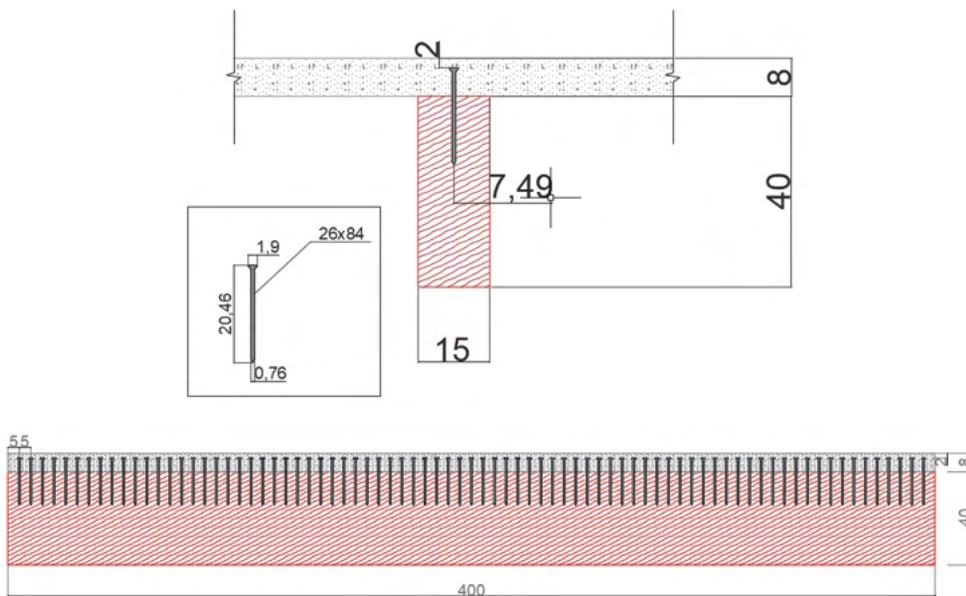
Detalhe da seção transversal e longitudinal da viga mista (cotas em cm)
